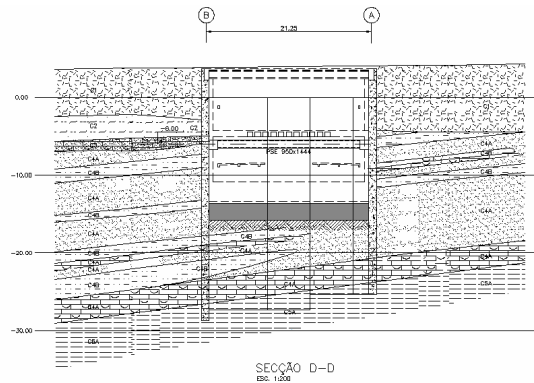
Corte transversal da estação. Fundações das paredes moldadas na camada C5
